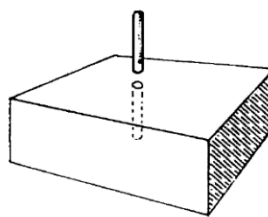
Typy zabetonovaných závitových pouzder [2]
